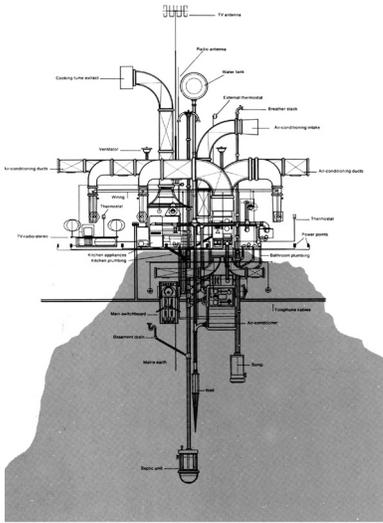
Anatomía de una vivienda. Fuente: Reyner Banham, 1965.
